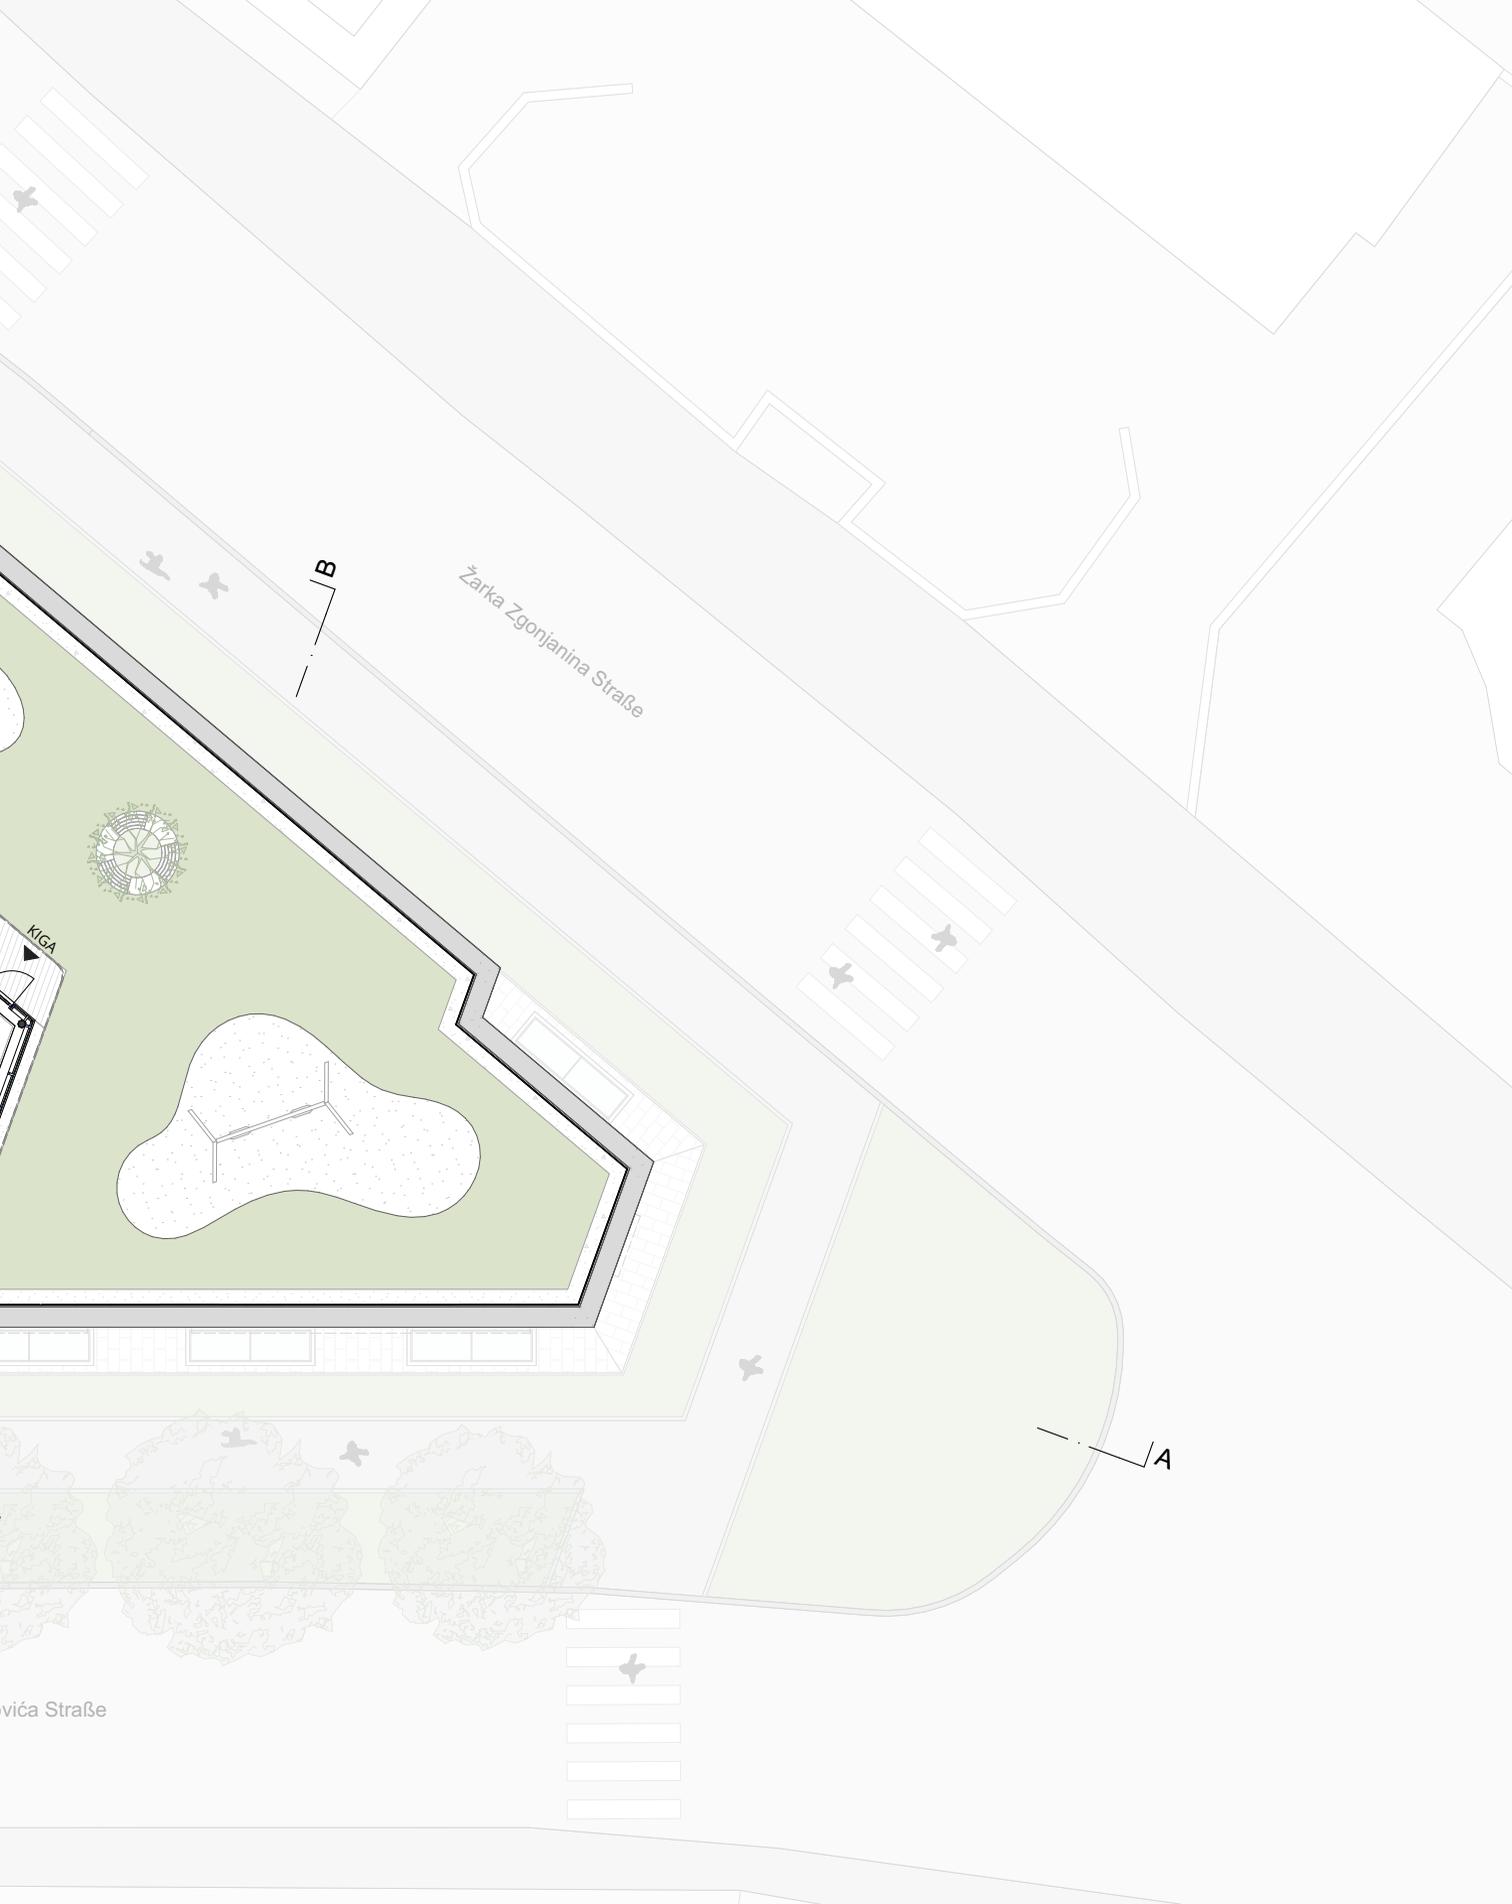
Grundriss Dachterrasse (Kindergarten Spielplatz) M1 : 200
